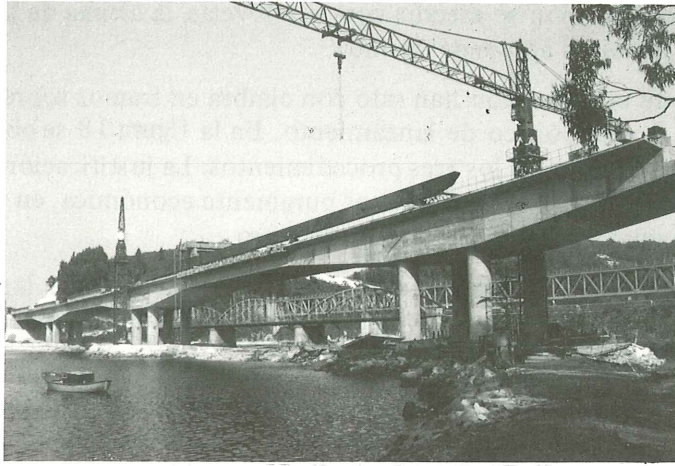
Vista de lanzamiento de V.P. Hormigonado tramo central.
